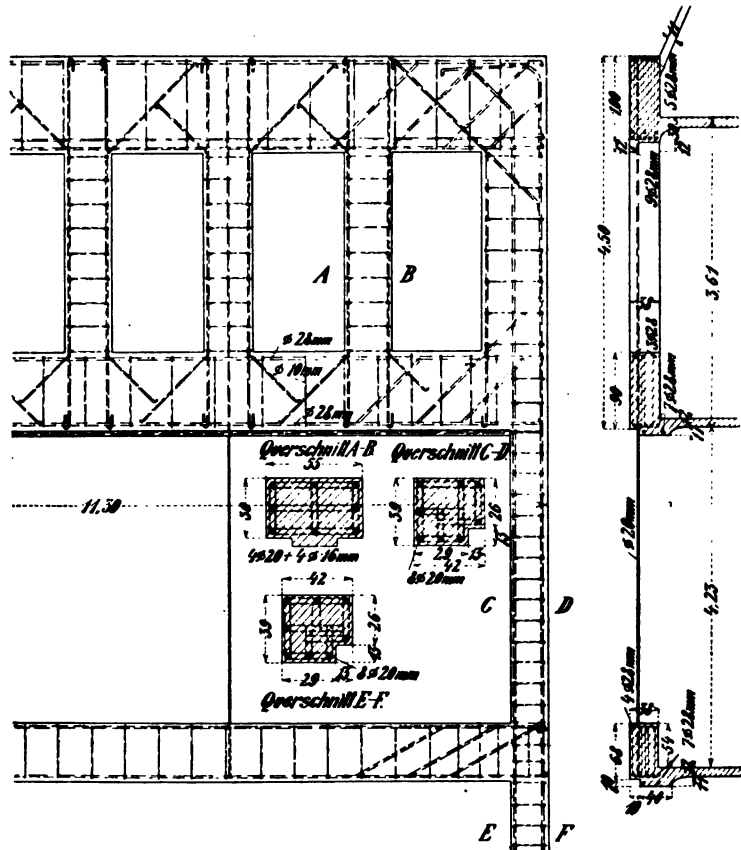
und 35. Eisenbetonfachwerk in Ansicht und Querschnitt. Frontträger für ein Warenhaus in Bremen.
